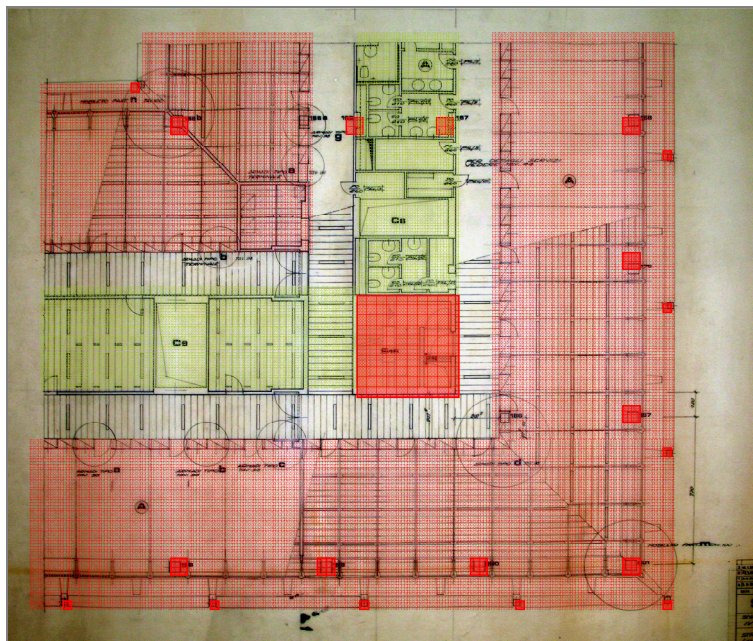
stralcio piano tipo (angolo)(fonte CSAC – stralcio tav. 55 bis, archivio n. 384-5 – rielaborazione f.m.)
